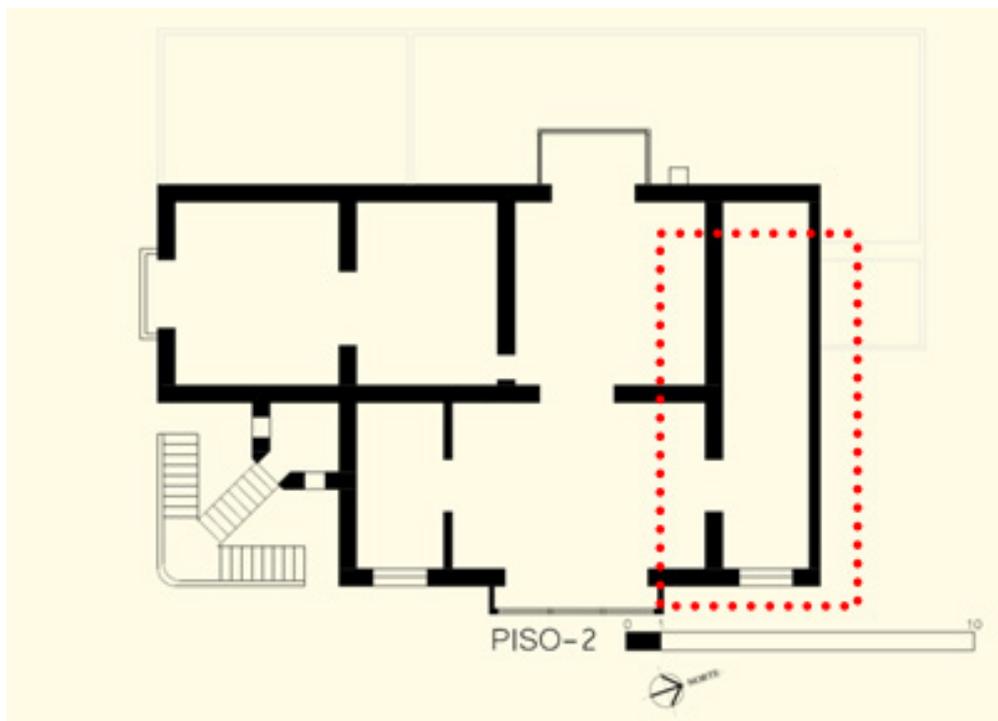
Antiga localização da escada no primeiro pavimento. Fonte: levantamento realizado por DPJ em 2014-2017 e adaptado por Caroline M. F. Rodrigues e Ailla C. de C. Raiol, 2018.
